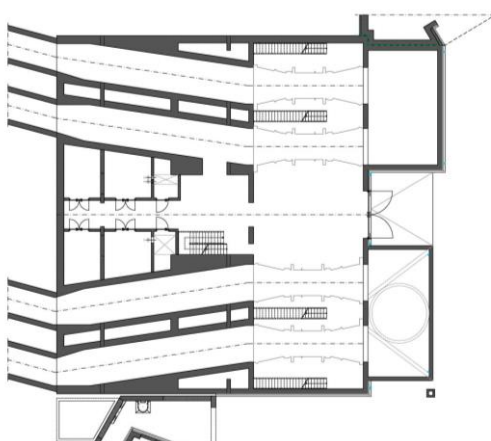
Pianta edifici D, E e G a quota 1308.60
